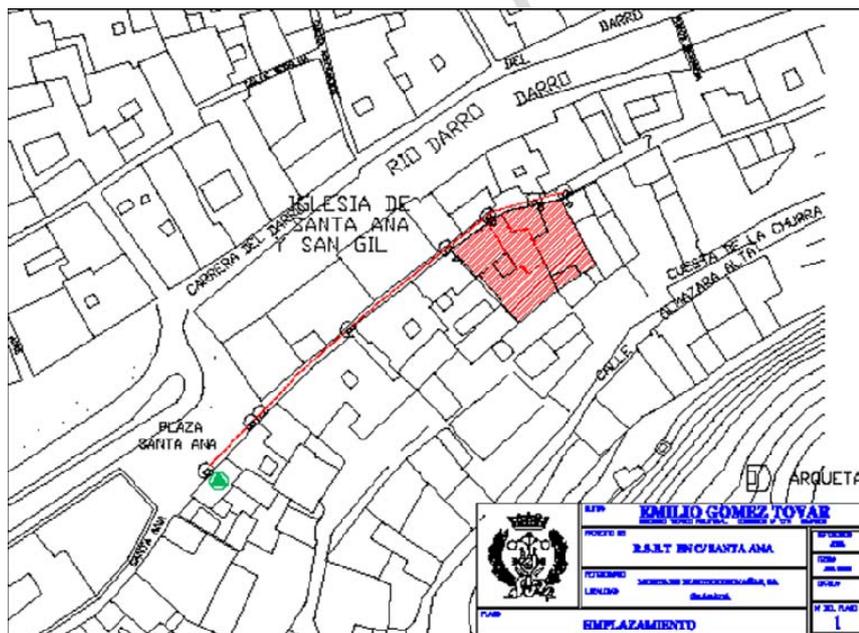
Plano de emplazamiento de la zona y trayecto marcado en rojo de la canalización.
